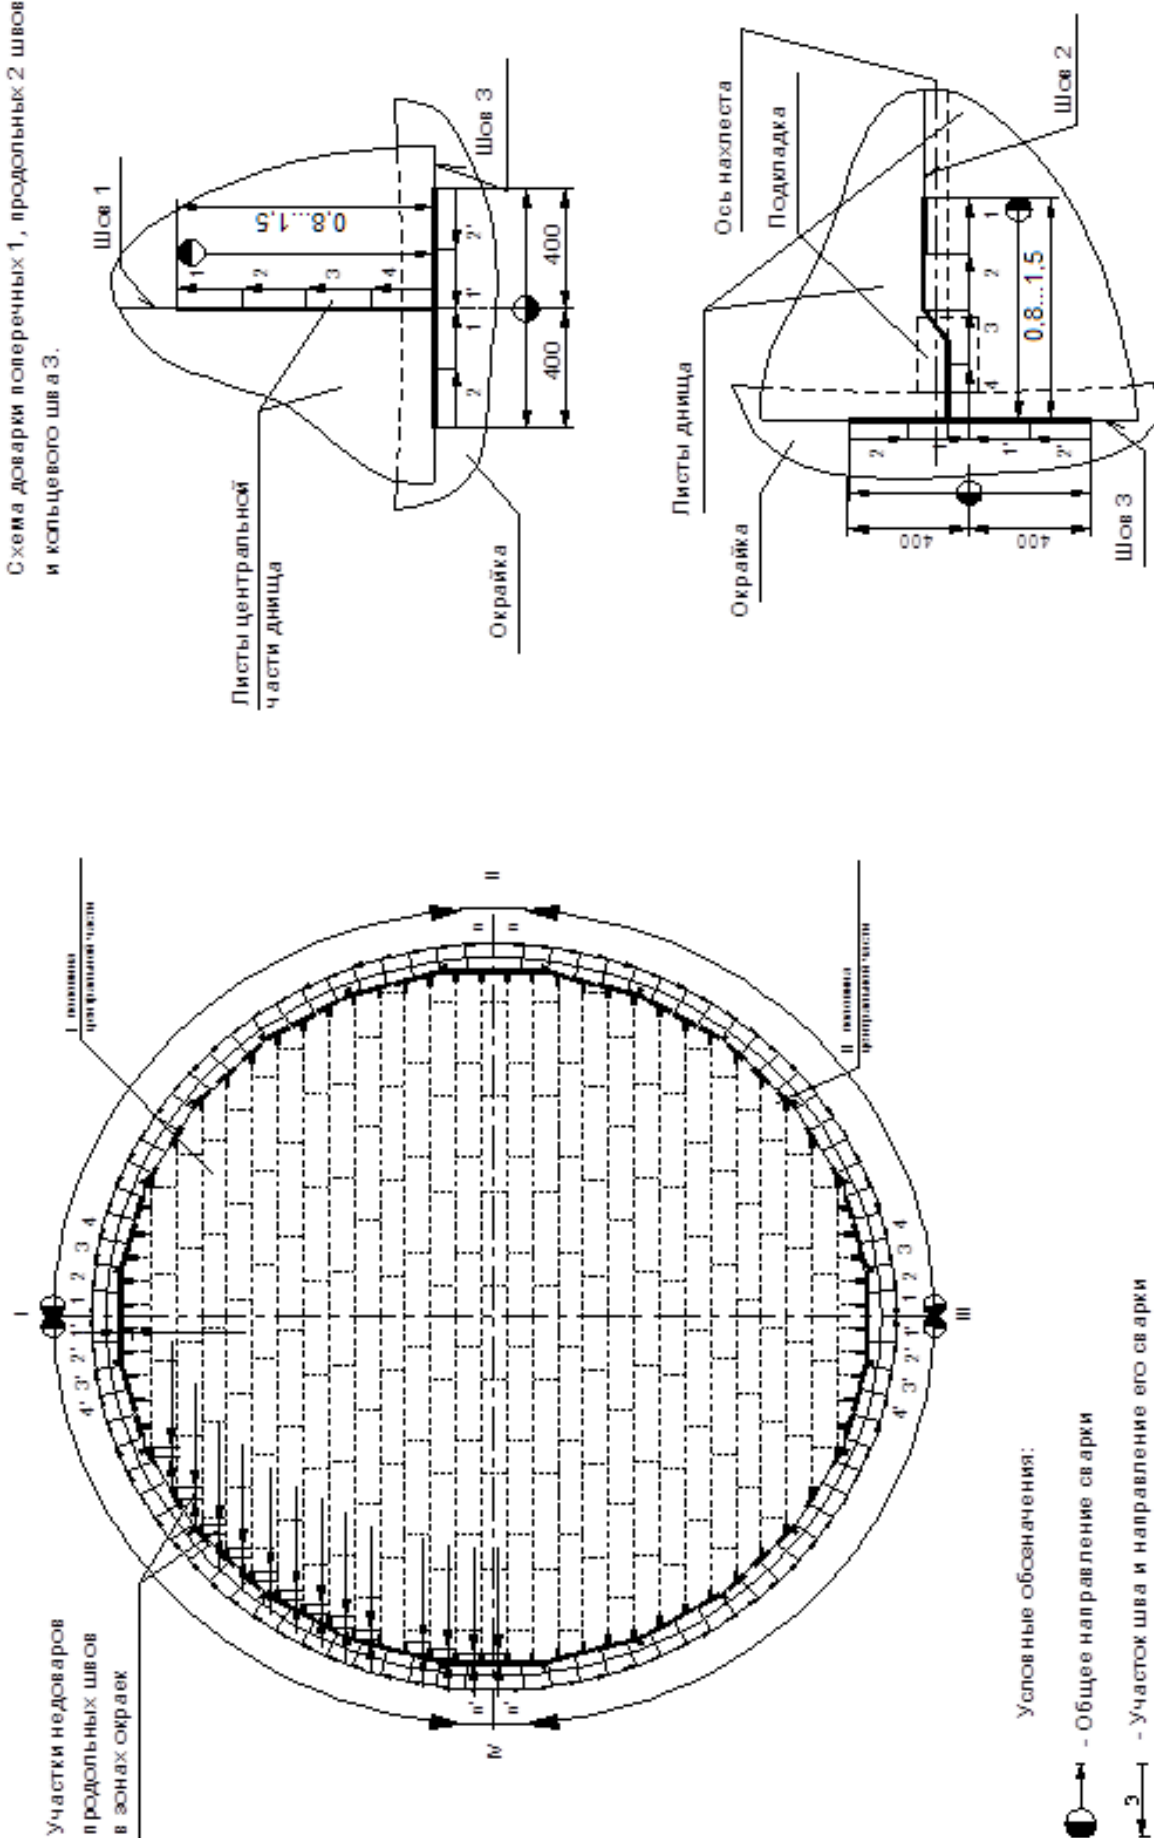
Последовательность сварки центральной части днища
